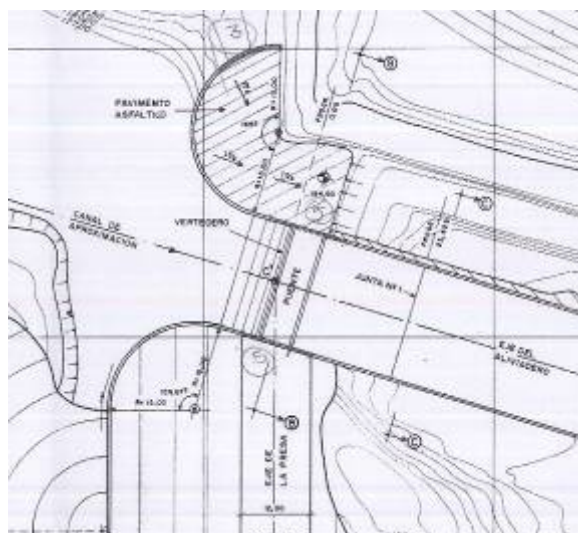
Vista en planta de la Embocadura del Aliviadero (Proyecto 1991)
